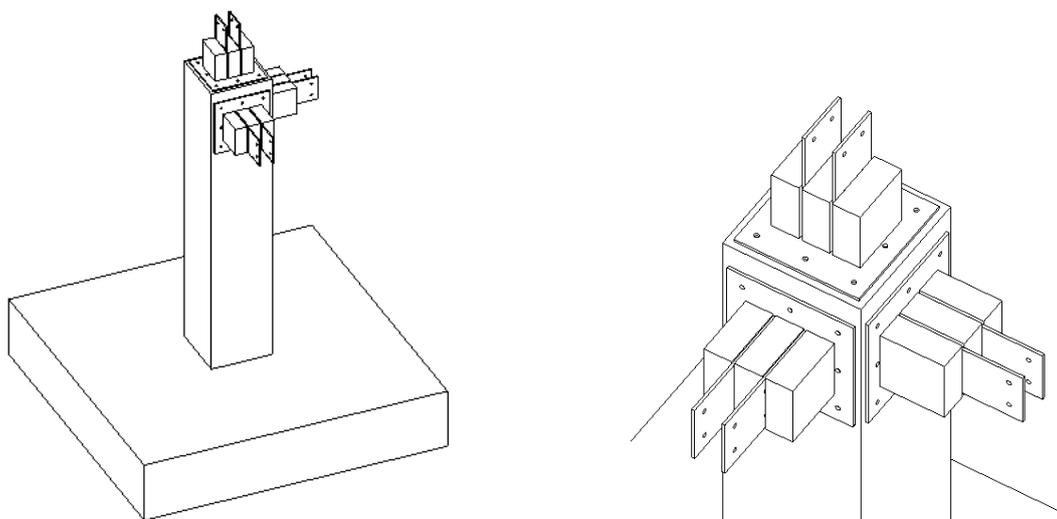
Conexión Estructural Hormigón - Acero - Madera. Elaboración Propia
